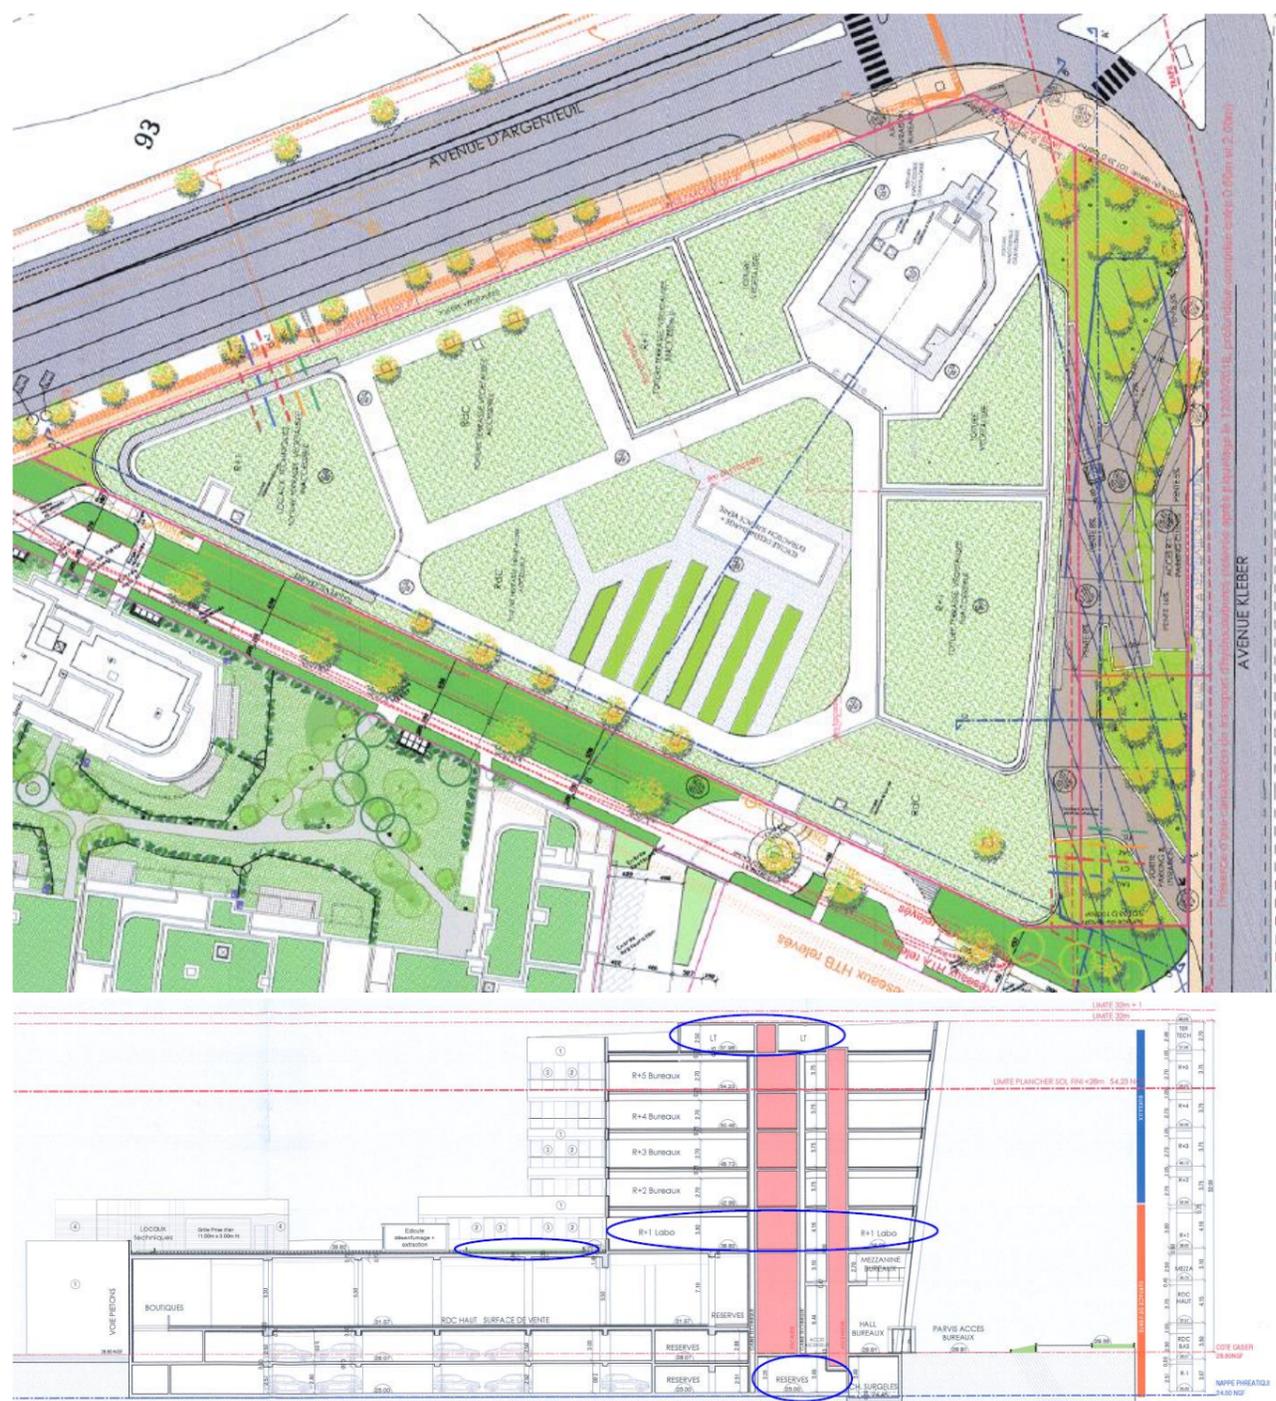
Plan de masse (en haut) et coupe du projet (en bas) – Variante 2
